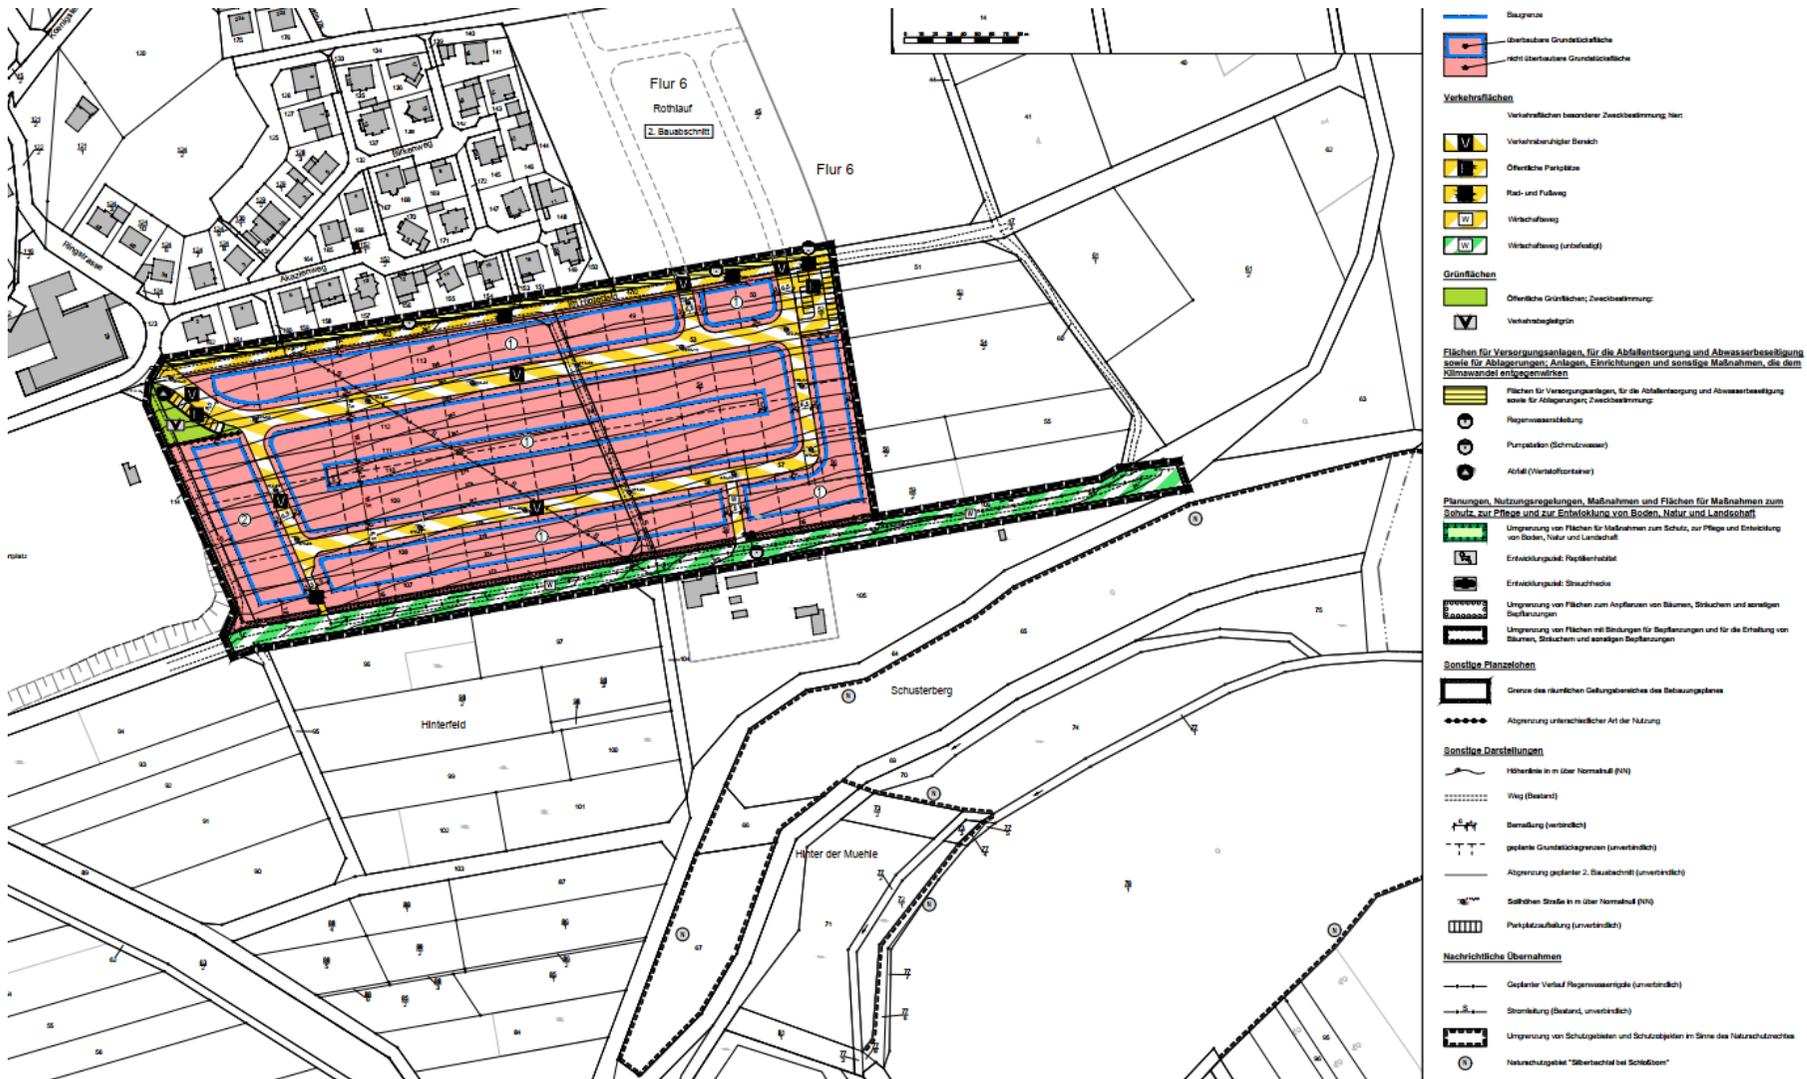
Bebauungsplan „Am Silberbach“ 1. Bauausschnitt; Stand 29.01.2020 (Quelle: Gemeinde Glashütten; Planungsbüro Fischer)
